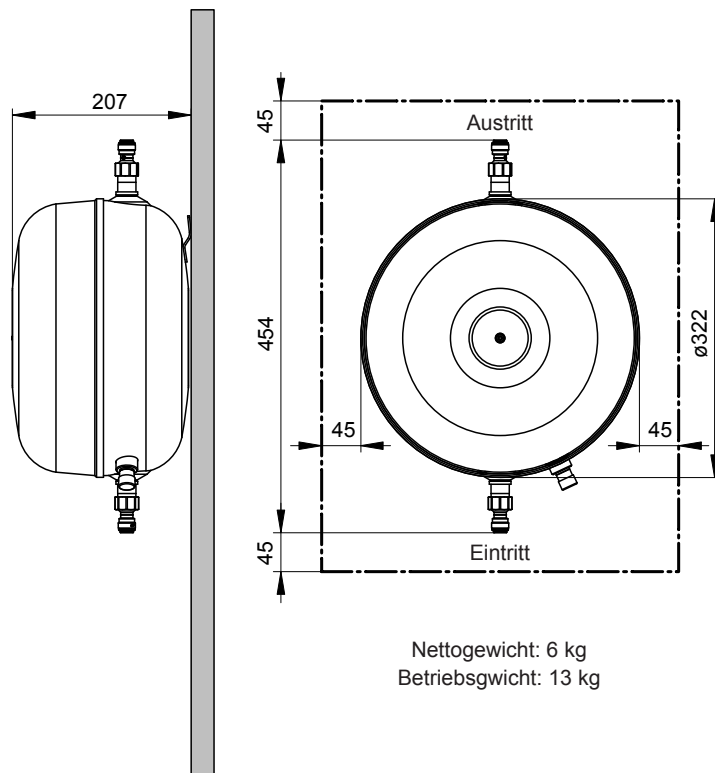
Abmessungen Durchlauftank (Masse in mm)
